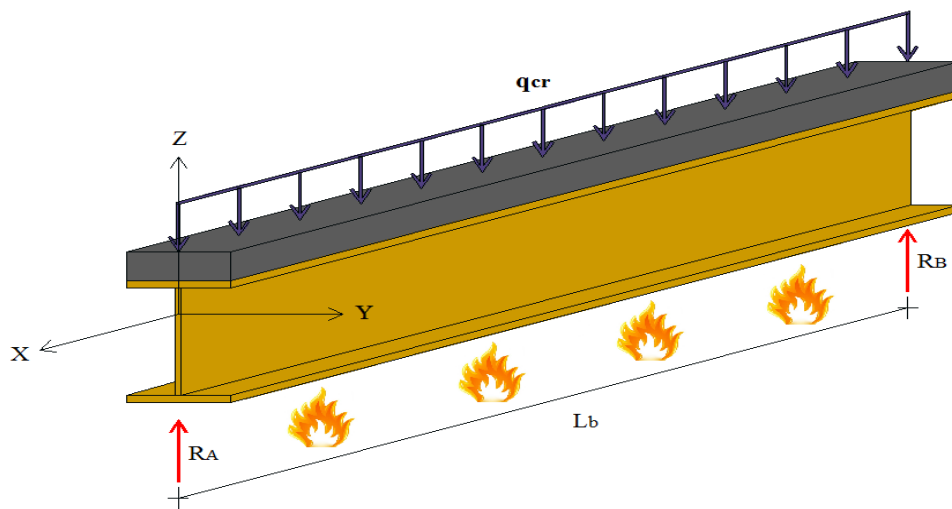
Viga I em perfil metálico, com carga uniformemente distribuída, submetida à situação de incêndio – Perfil sem revestimento.
